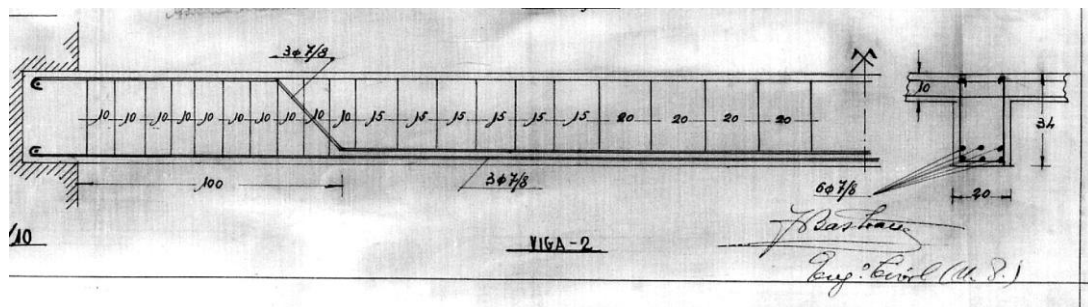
Pormenor construtivo da viga do pavimento do piso 1 [6]
